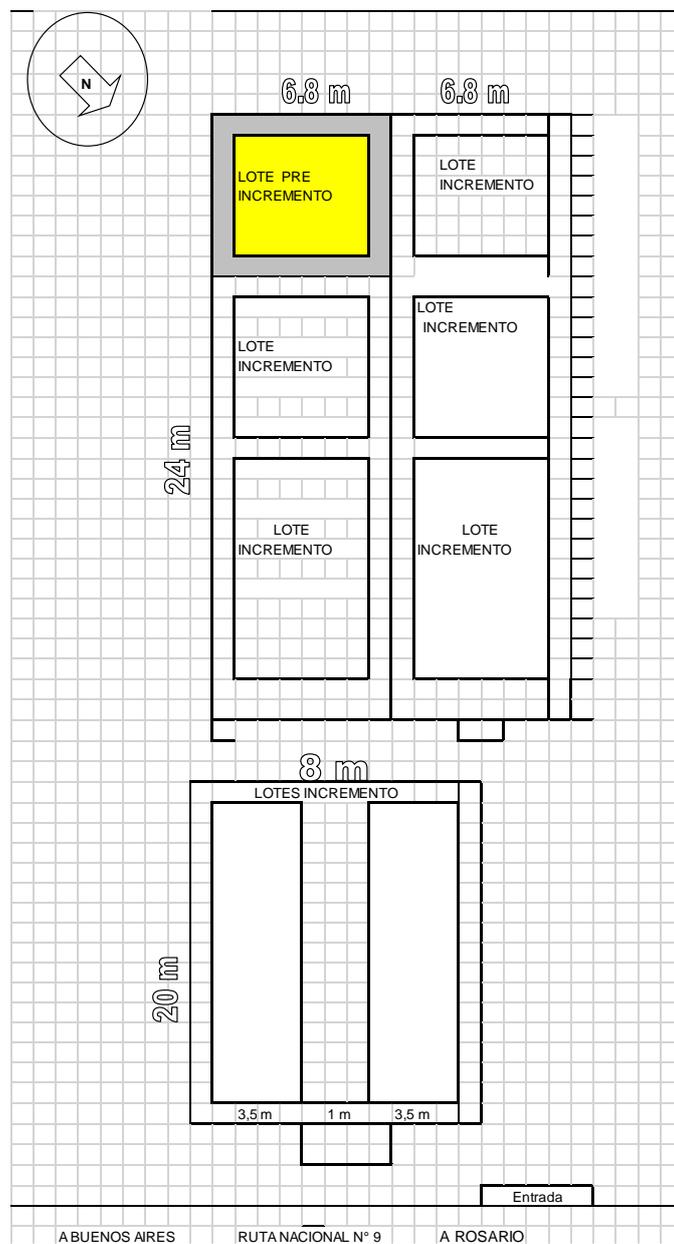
Vista en planta de los invernáculos – orientación – dimensiones – ubicación de lotes de preincremento e incremento.
